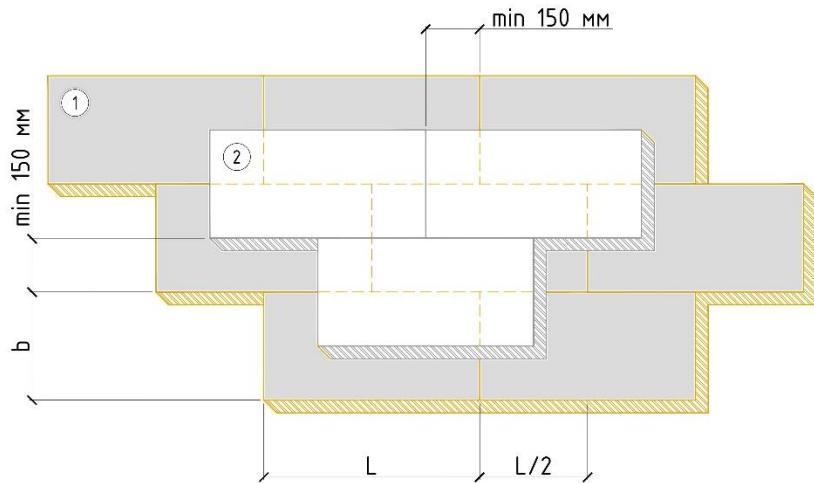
Смещение плит верхнего и нижнего слоев при укладке.
